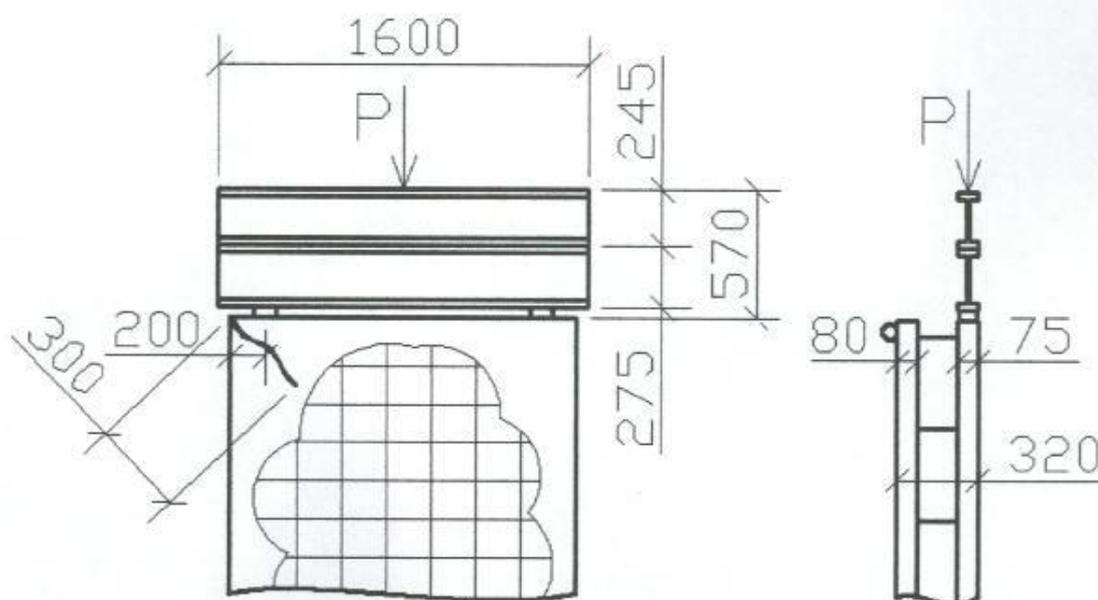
Распределительная балка для передачи нагрузки на испытываемую панель
